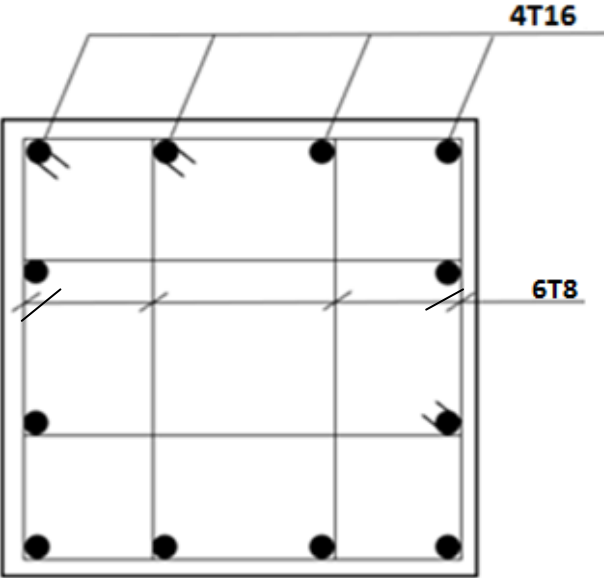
Schéma de ferrailage du poteau 45x45
